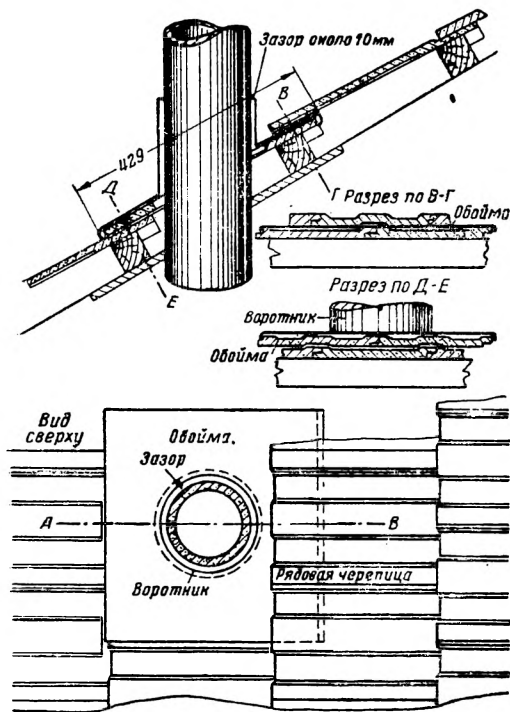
Обделка примыкания черепичной кровли к вентиляционной трубе
